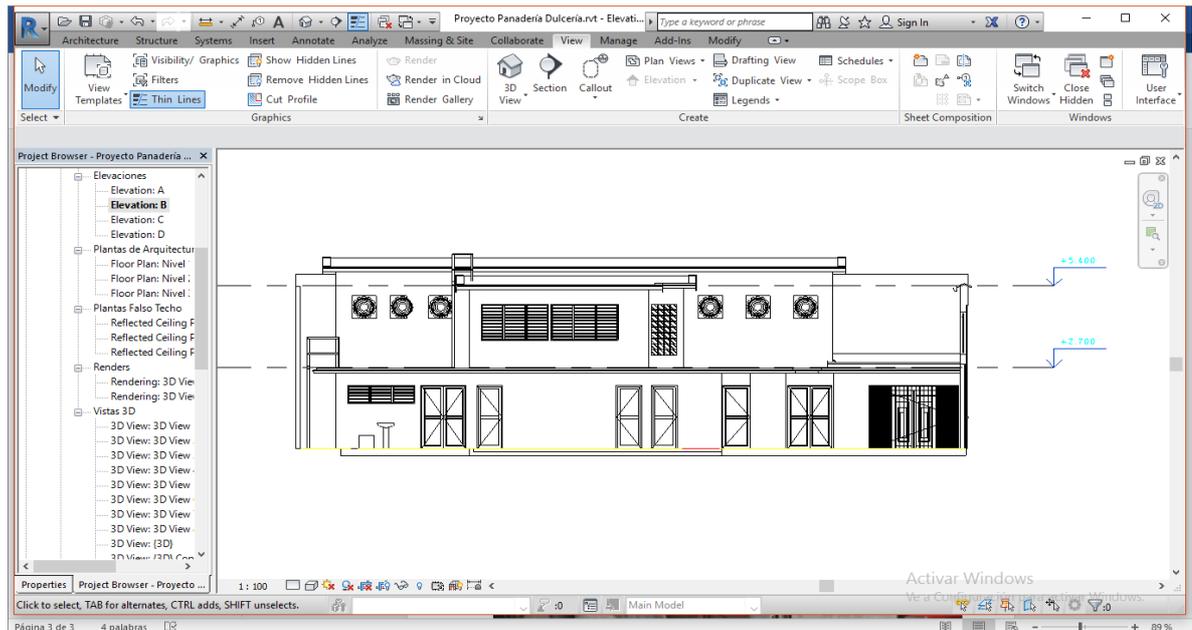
Vista de los niveles de la parte lateral del edificio. Fuente: Proyecto “Panadería Dulcería “*Empresa IDEAR de Cienfuegos.
